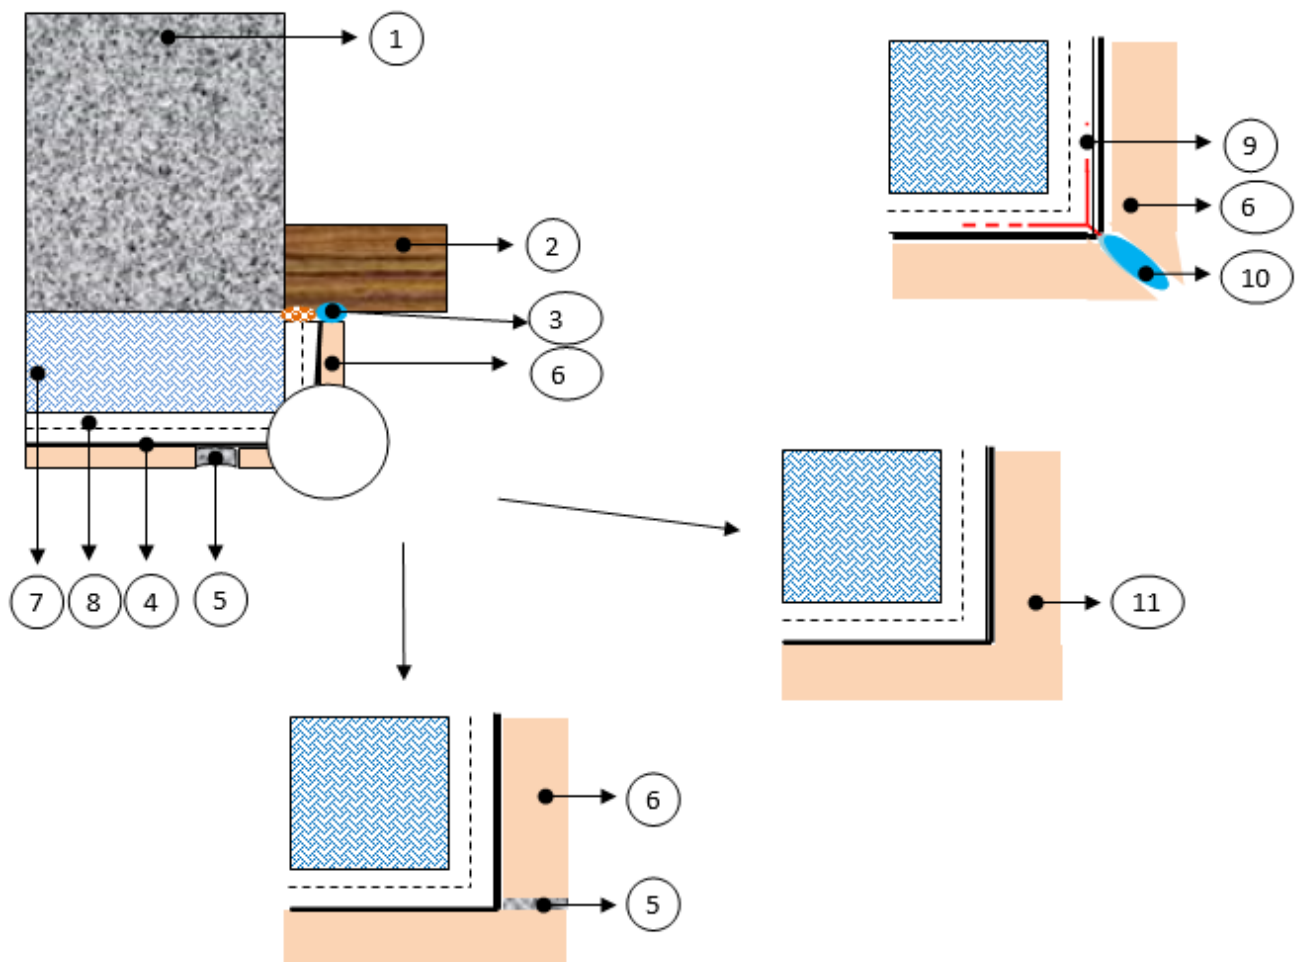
Système Rhéatherm 600 avec finition de type « plaquette de parement en terre cuite » : raccordement avec un système d'enduit SUR isolant (fixation de l'isolant sur la maçonnerie non symbolisée).
